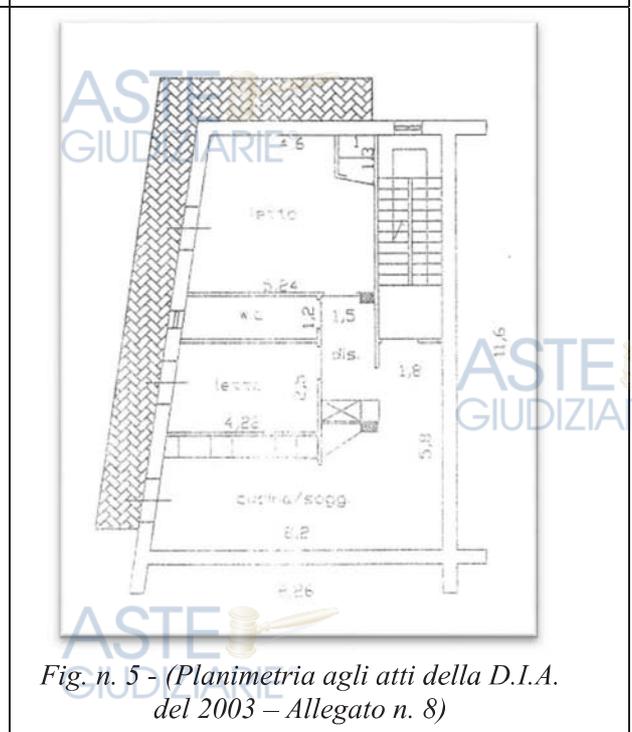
(Planimetria agli atti della D.I.A. del 2003 – Allegato n. 8)
